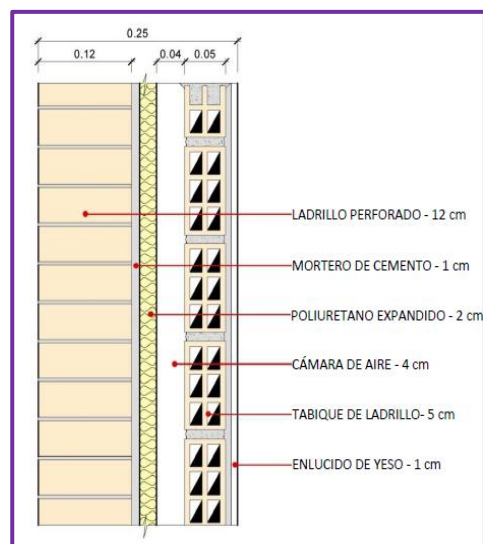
Detalle constructivo de muro caravista
